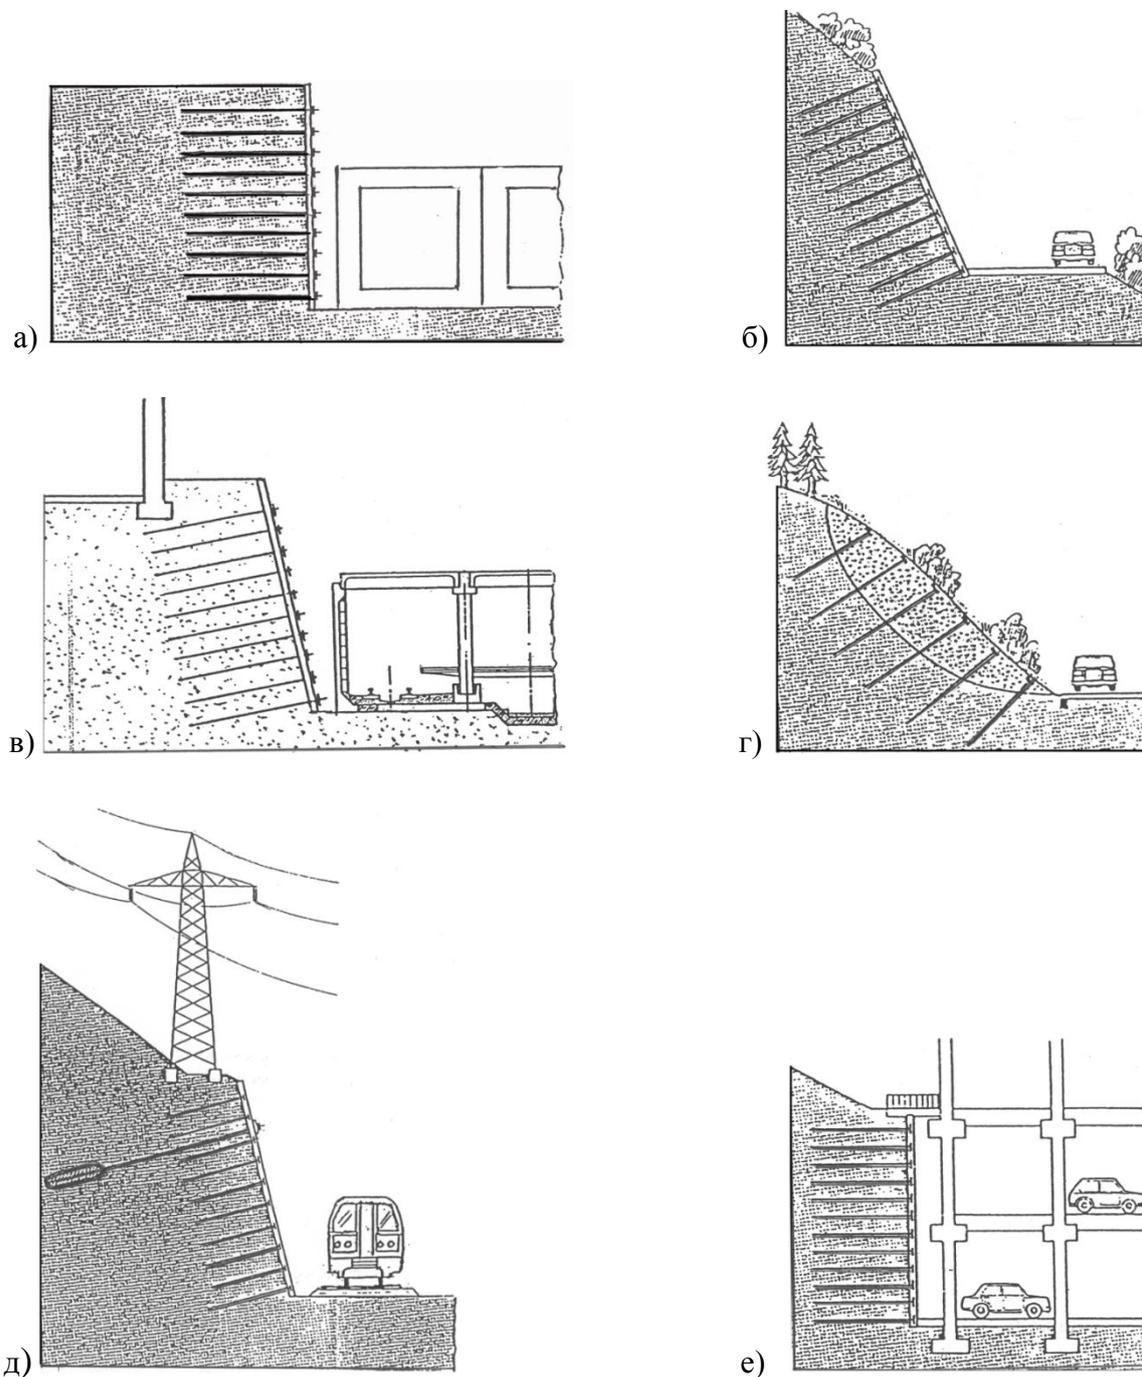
Примеры применения нагельного крепления котлованов и откосов стержнями из композитной неметаллической арматуры:
